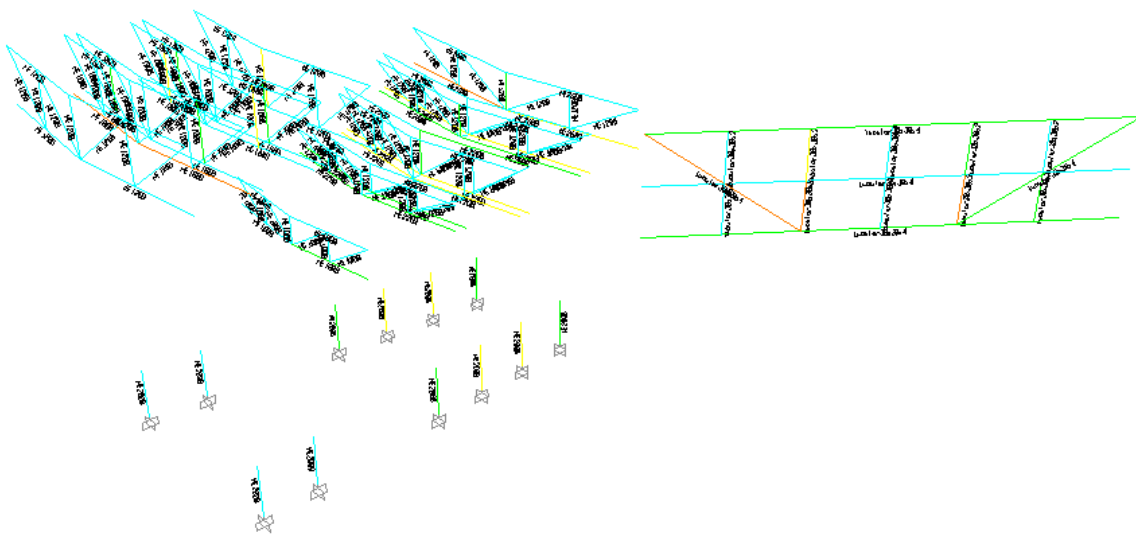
ANÁLISIS DE LAS BARRAS DE LA ESTRUCTURA.
